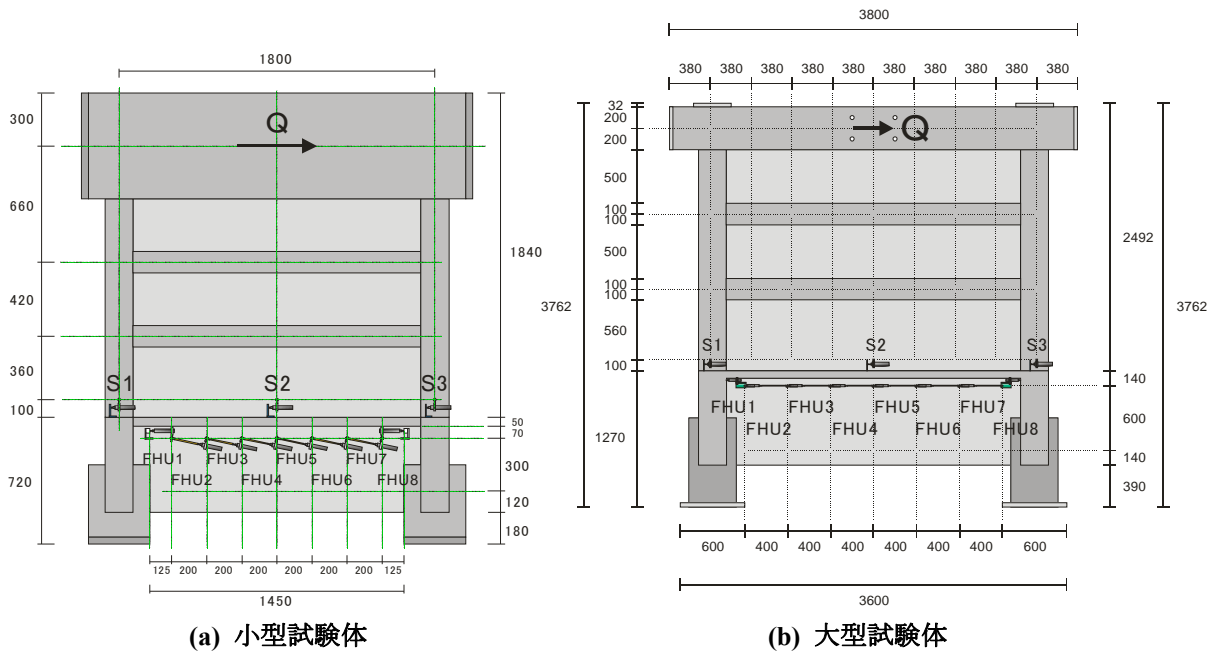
基礎梁と耐震壁脚部の変位計設置位置 (単位: mm)
